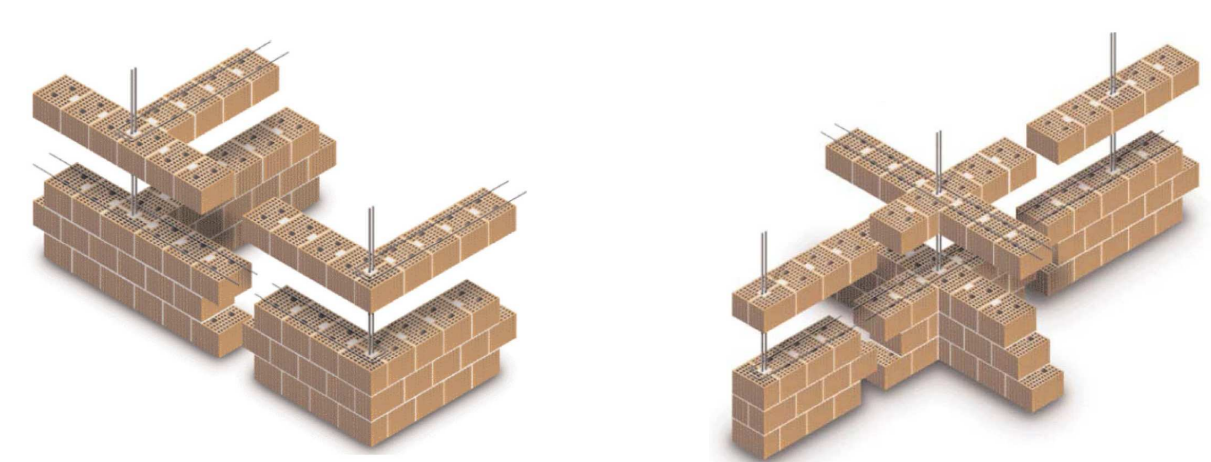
Particolare di incrocio perimetrale a "T" e a "L" (sinistra); disposizione delle armature ad interasse di almeno 4.0 m (destra)
